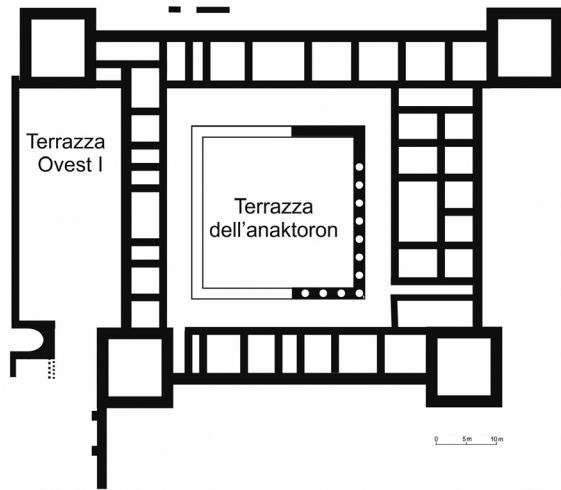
Dettaglio planimetrico del *phrourion* presso il palazzo greco di Demetriade (disegno dell'autore).
